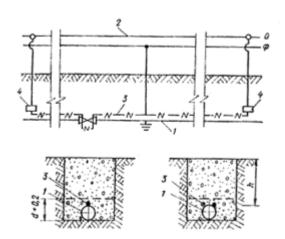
Схема оборудования водопровода греющим кабелем
